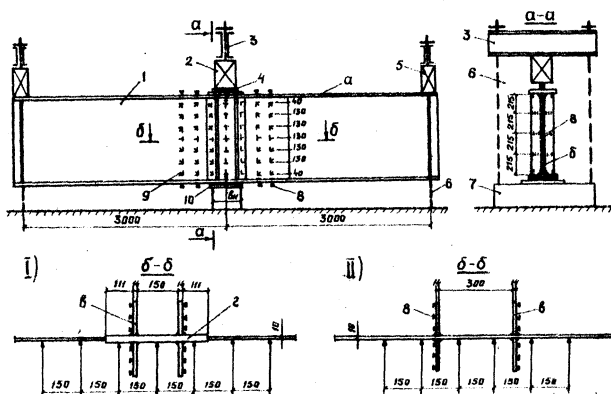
Схема испытаний фрагментов опорных участков натуральных балок:
